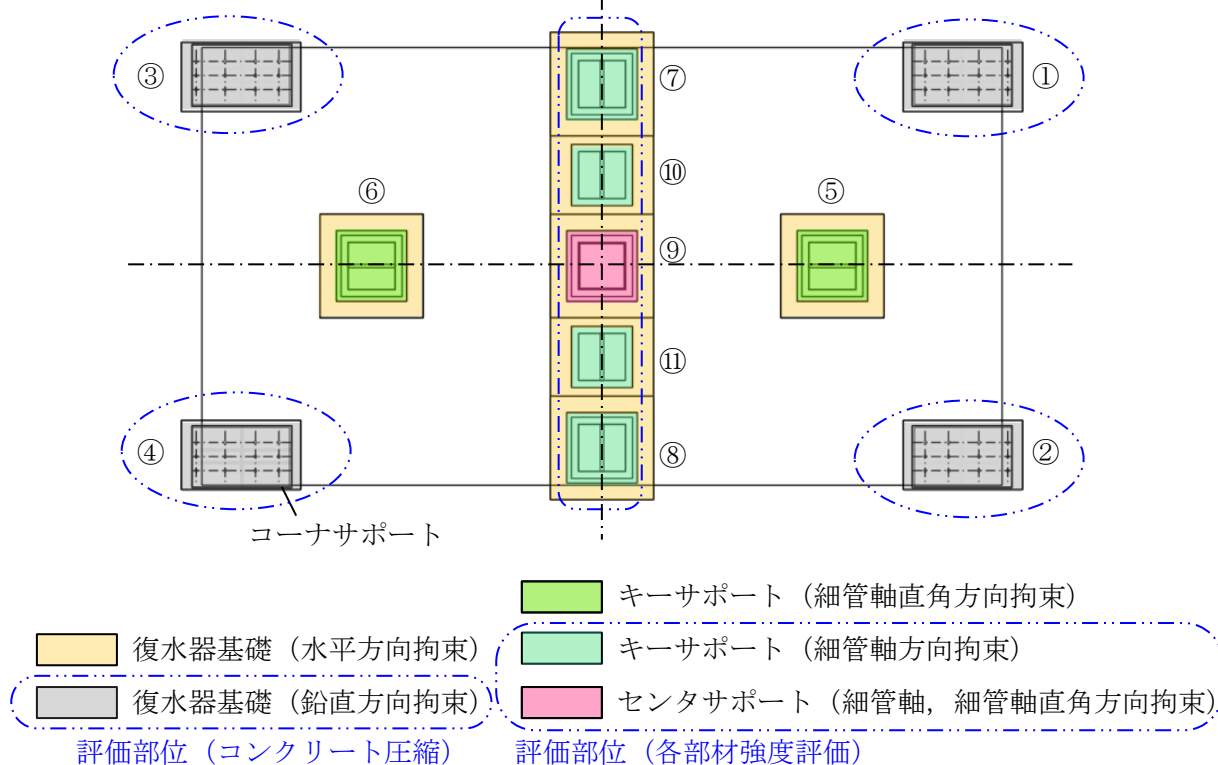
復水器基礎平面図 (復水器 1 胴分を示す)
